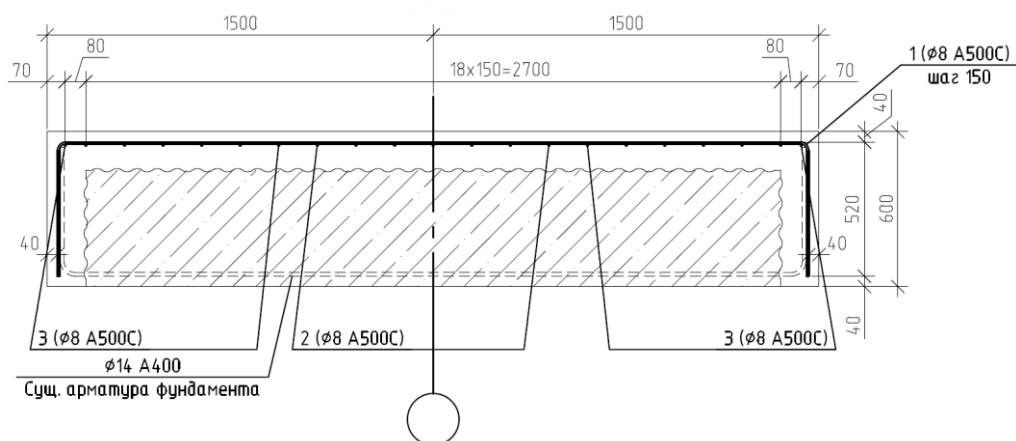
Установка дополнительной арматуры без анкерования в бетон
